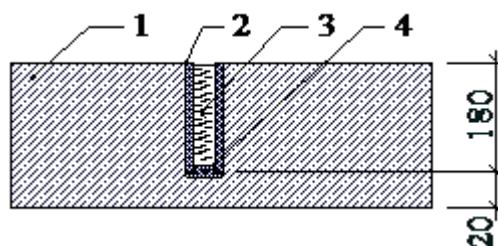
Устройство температурной скважины: 1 – бетон плиты перекрытия; 2 трубка ПВХ 25; теплопроводная жидкость – масло; 4 – заглушка
